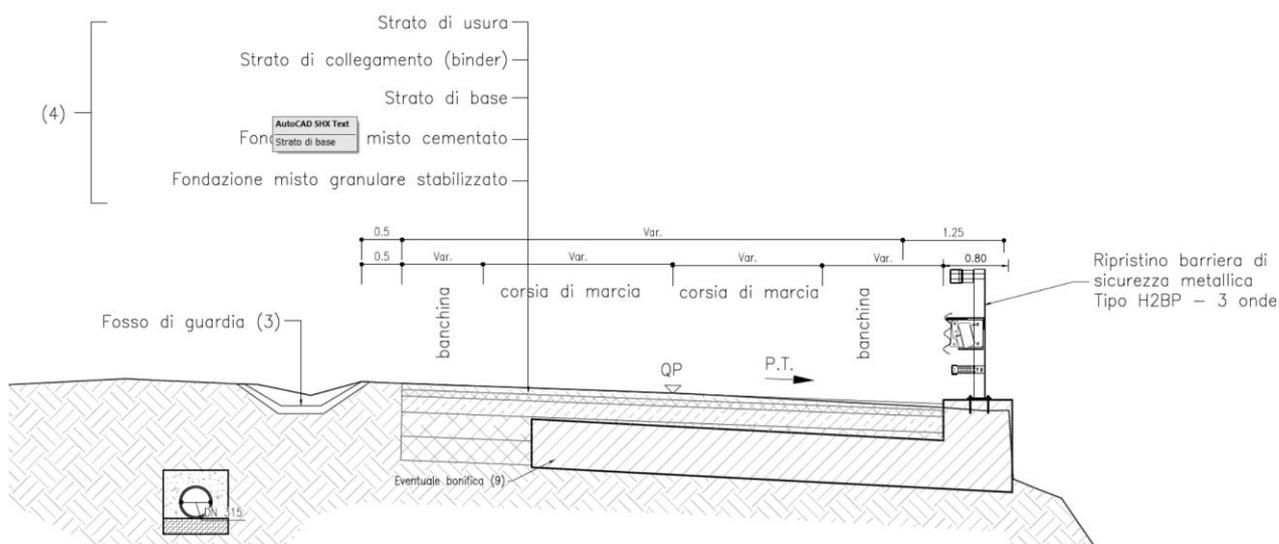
Sezione tipologica di ripristino della viabilità S.P. 27 sul sedime esistente sul tratto in corrispondenza della galleria
